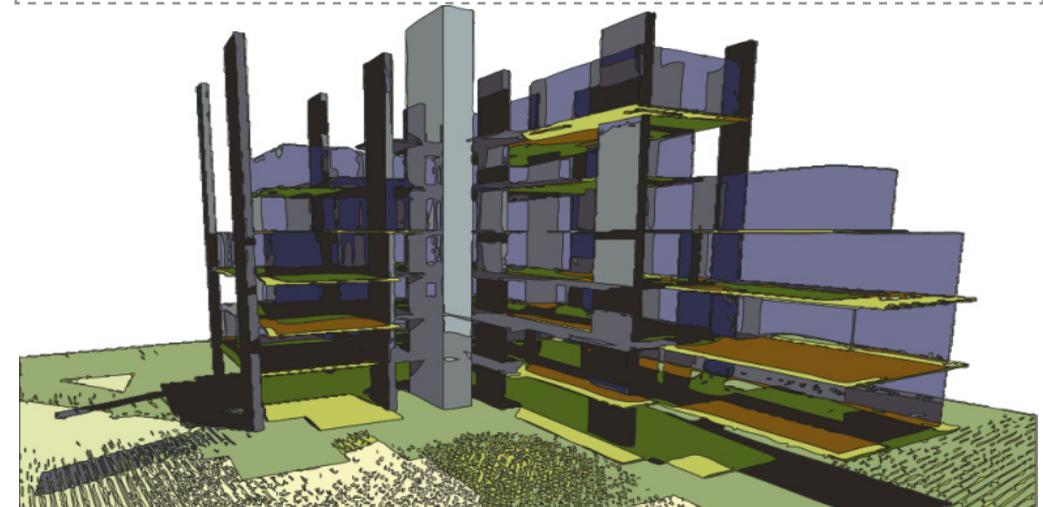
Modulación conceptual del sistema constructivo de muros. Y sistemas prefabricados. Fuente: Elaborado por el Autor.
